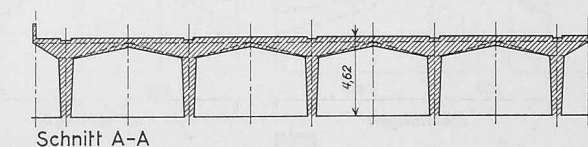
Verwaltungsgebäude der Durand & Huguenin AG in Basel. Decke über Erdgeschoss, Grundriss und Schnitte 1:450
